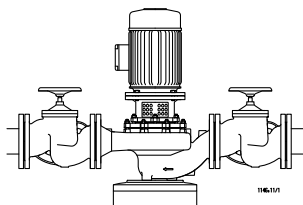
Vertikal konstruksjon/festing med pumpefot (støpejern, tilbehør), dimensjoner 100-100-160 til 200-200-315
